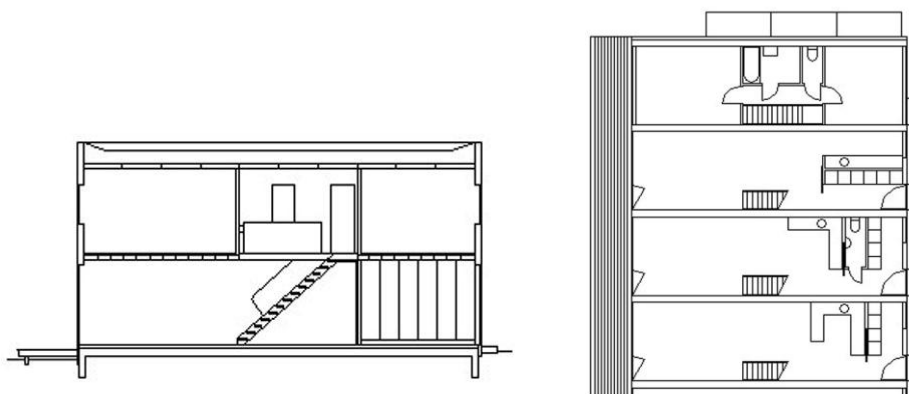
Розріз та варіанти планування першого поверху комплексу дешевого житла для молоді у м. Руднік. Чехія
